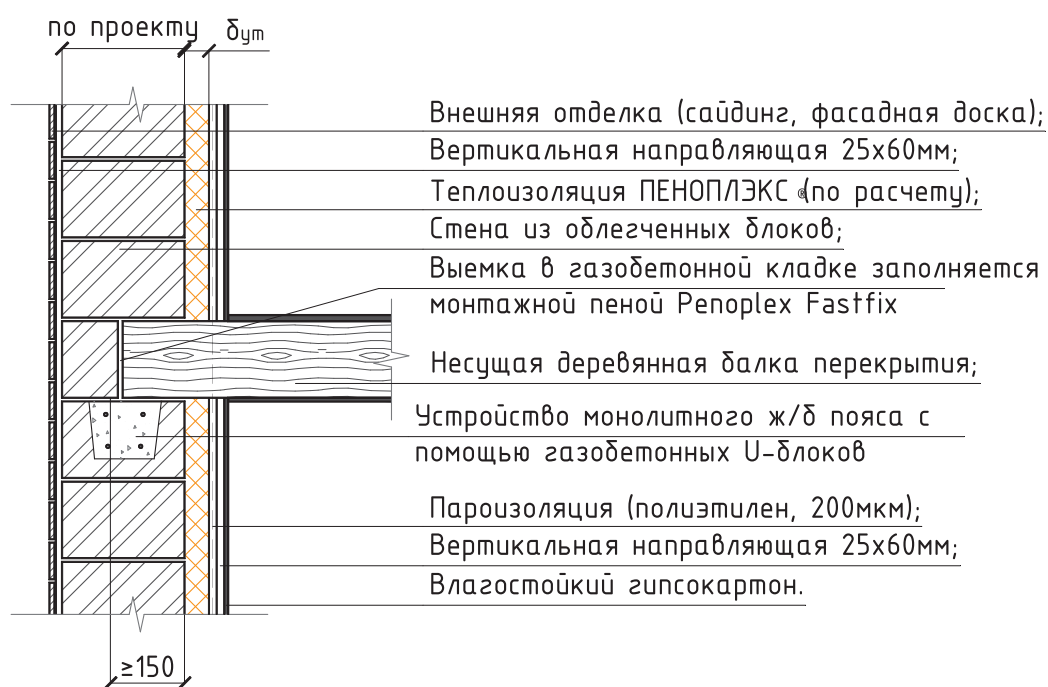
Схема сопряжения стены из облегченных блоков с деревянным перекрытием (плиты ПЕНОПЛЭКС® изнутри).
